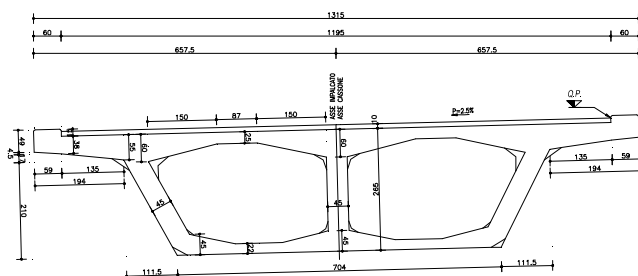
Sezione trasversale impalcato in mezzzeria – Progetto Definitivo
